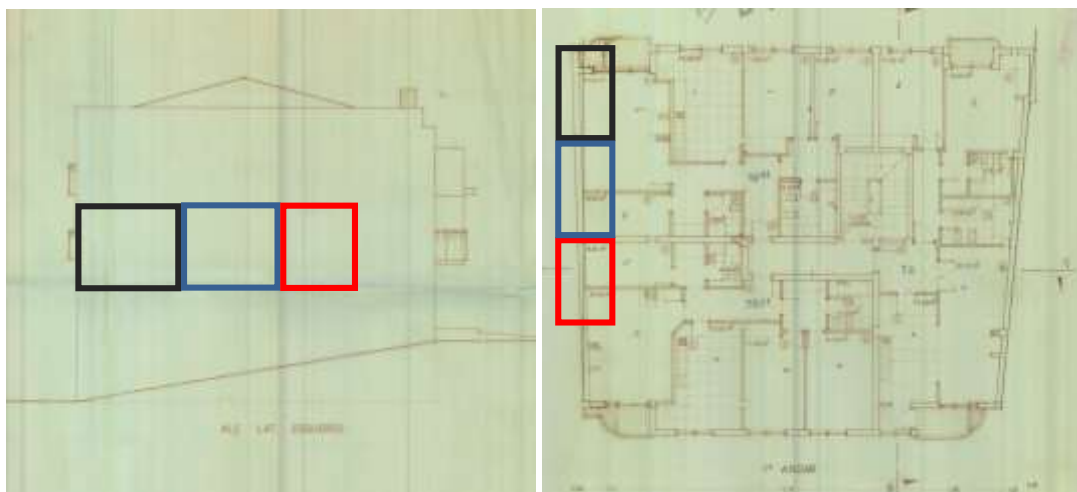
Localização da parede no alçado esquerdo e na planta arquitetónica do primeiro piso do edifício.
